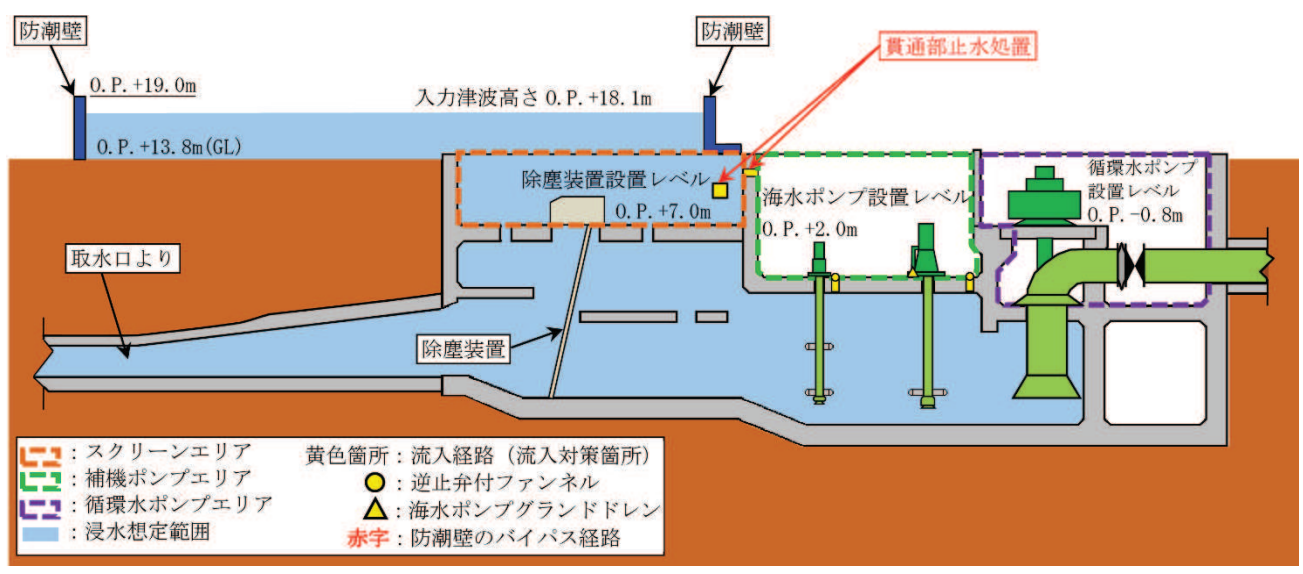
第 2 号機 海水ポンプ室 流入対策配置図 (A-A 断面図)
